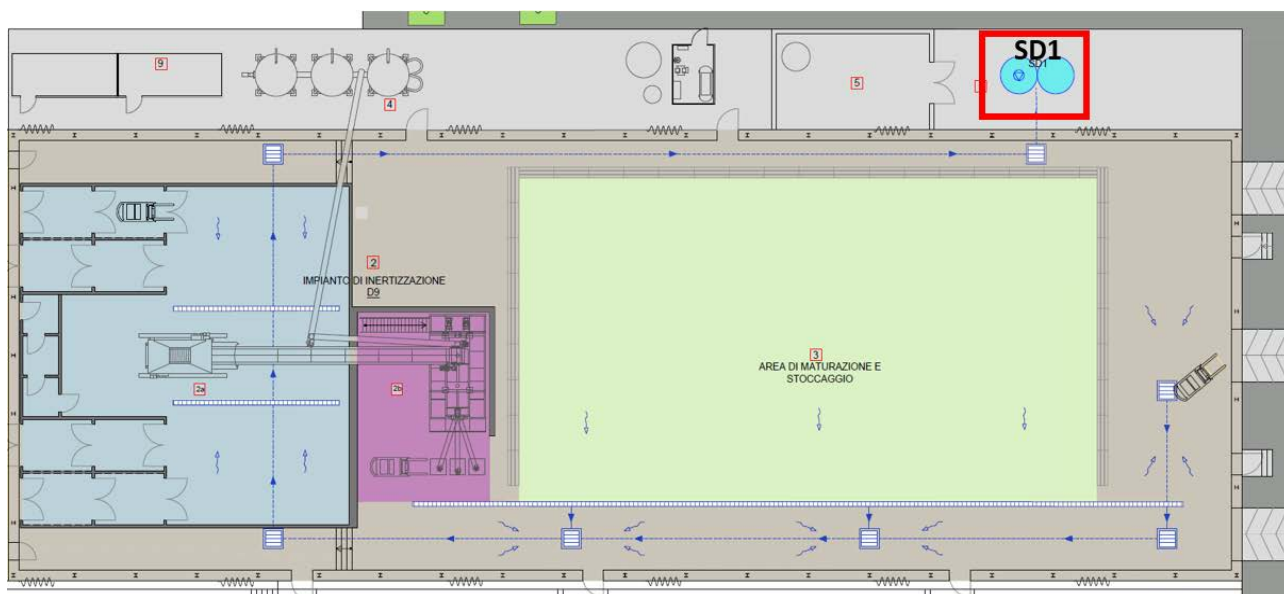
Estratto dall'elaborato AIA - All.2d Planimetria reti fognarie scarichi liquidi impianto di inertizzazione
